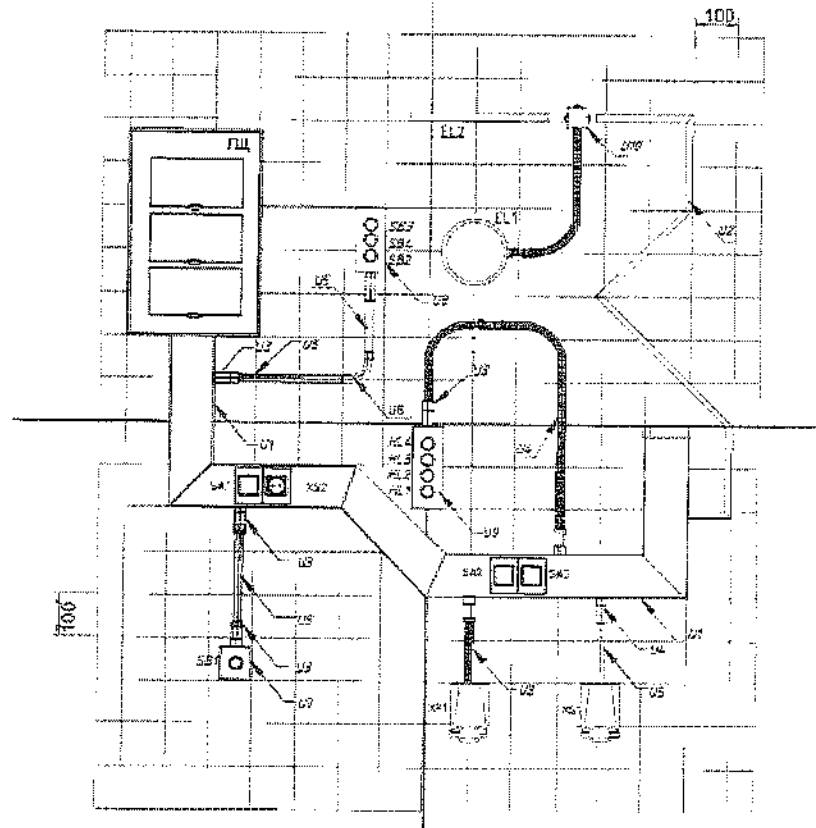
Пример планируемой для разработки монтажной схемы в среде AutoCAD
